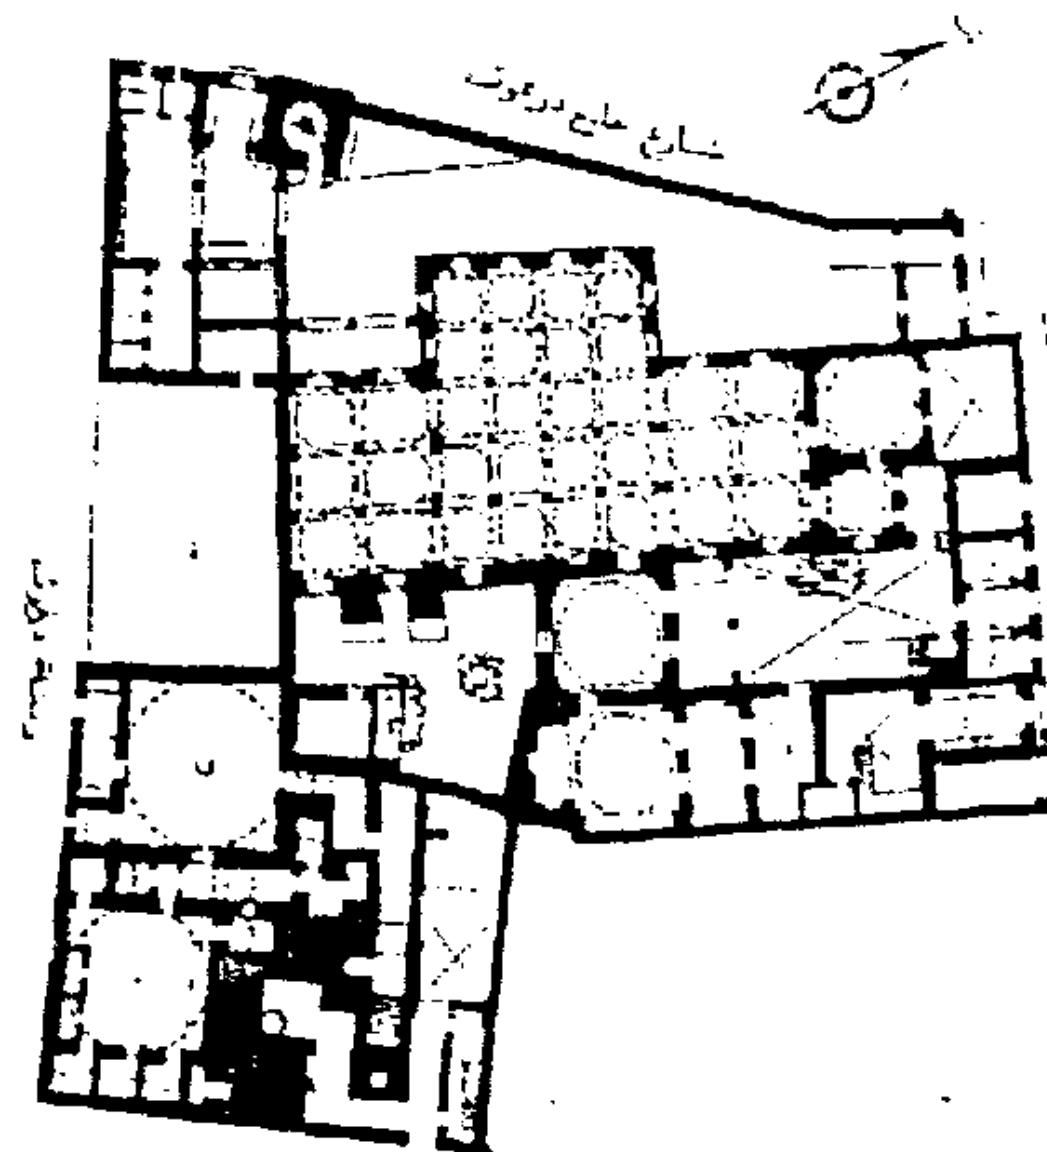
مسقط أفقى لجامع سالم المشاط عن الموسوعة (الجزء الأول).
